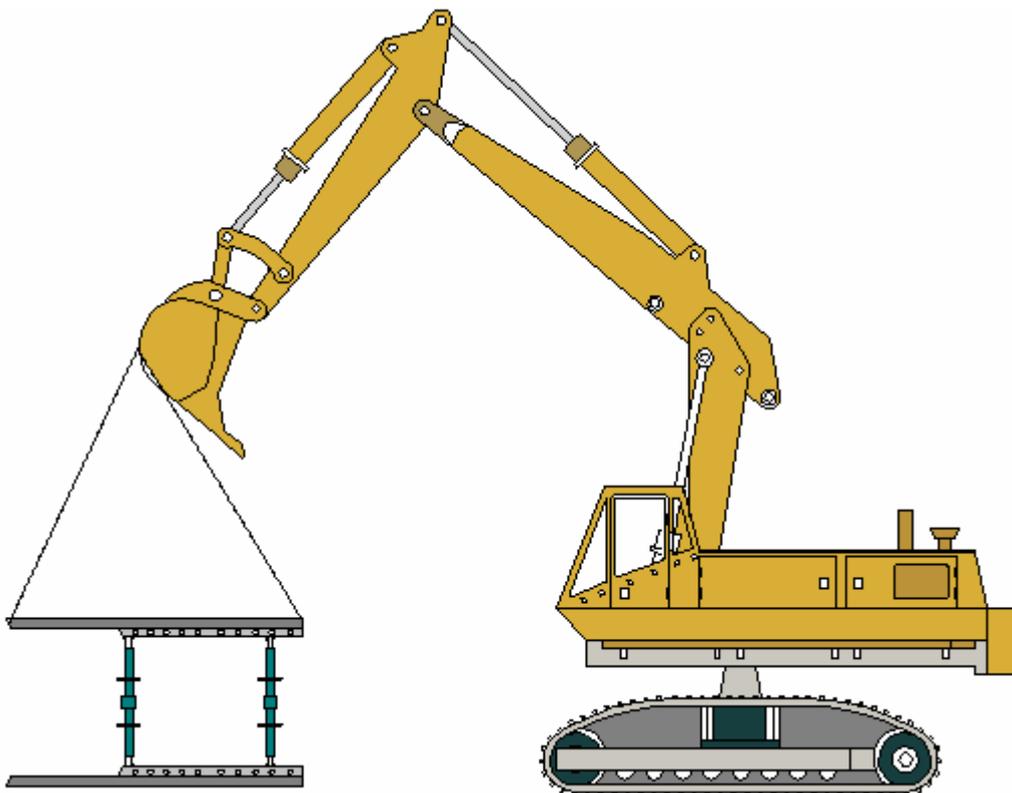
Ensamble Final del primer modulo, Sistema de Cajones utilizando una excavadora./Elaboración Propia.
